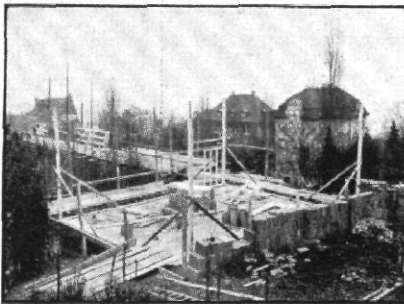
| Erster Tag. Die fertige massive Erdgeschoßdecke über dem Keller. Die 4 durchgehenden Eckpfosten stehen.
